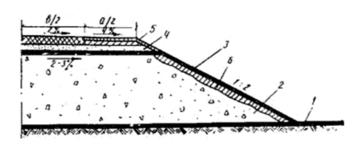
Конструкция насыпи из крупнообломочных грунтов с защитными элементами из грунтов укрепленных органическими вяжущими
